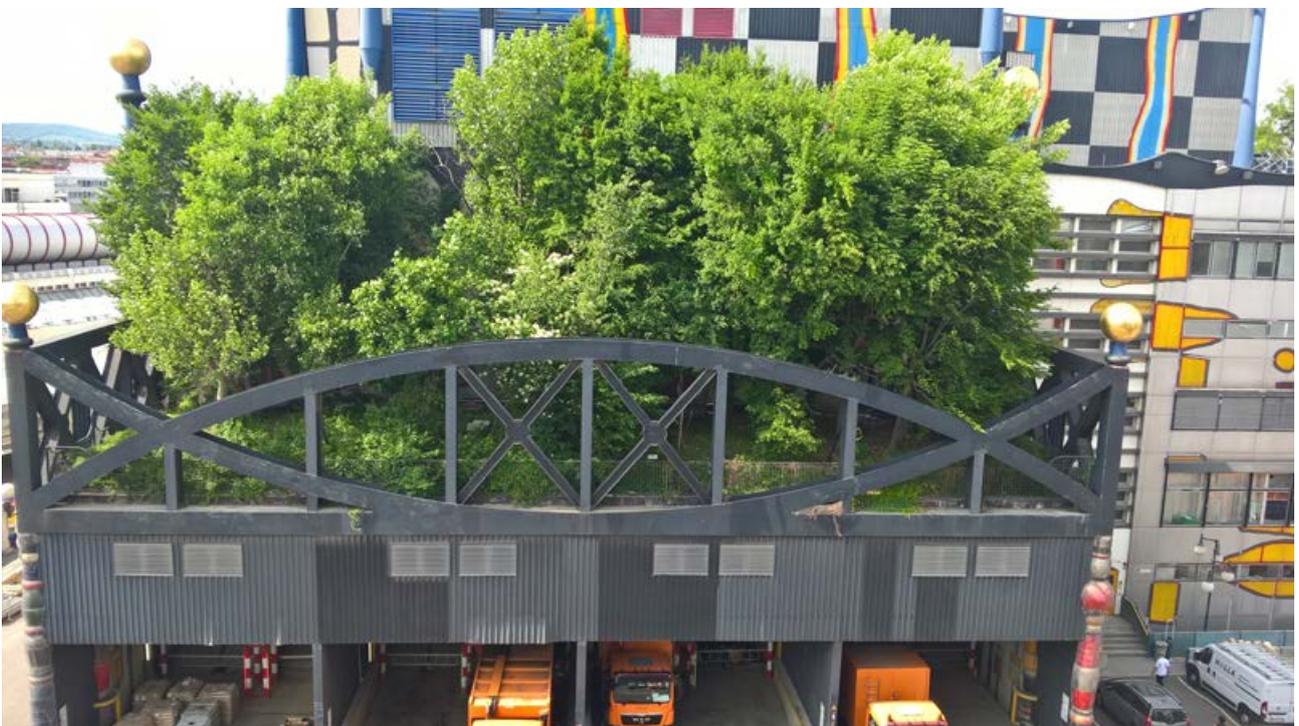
Intensive Dachbegrünung, Müllverbrennungsanlage Spittelau (Quelle: Jürgen Preiss)
